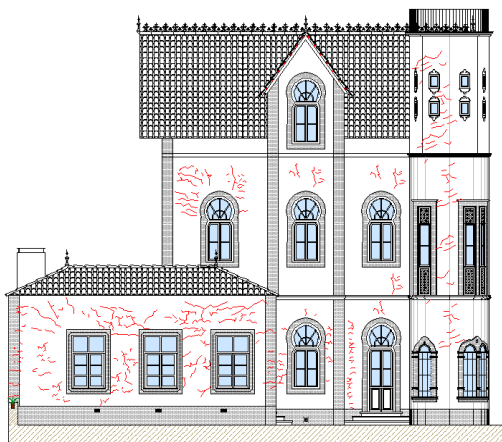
Localização em alçado da fissuração, destacamento do reboco tradicional nas fachadas exteriores.
